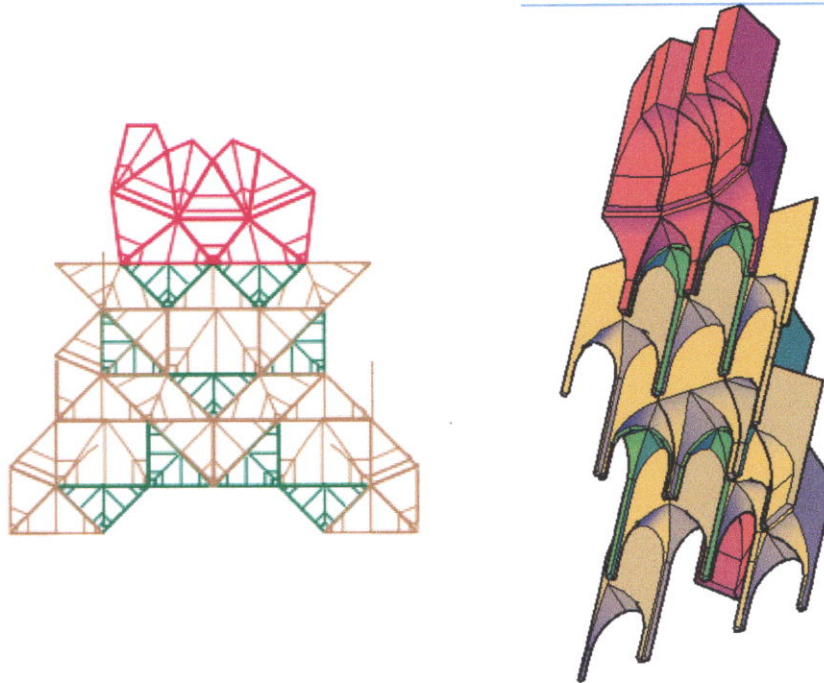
Croquis montrant la structure filière et ombrée du montage des pièces à Mouqarnas , dessiné par l'auteur
